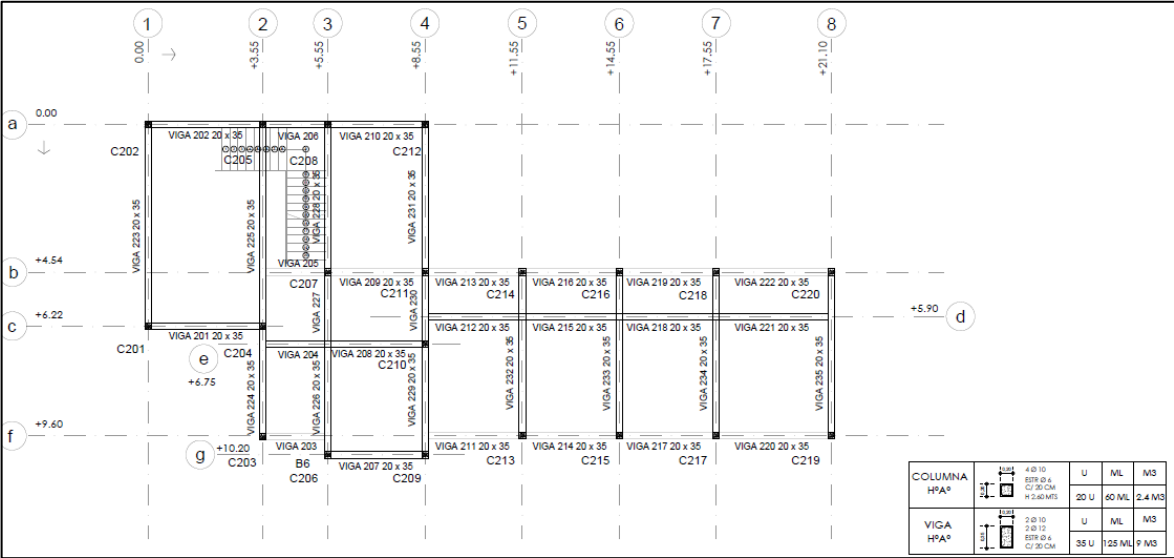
Esquema de estructura – Vigas sobre 1º Piso
